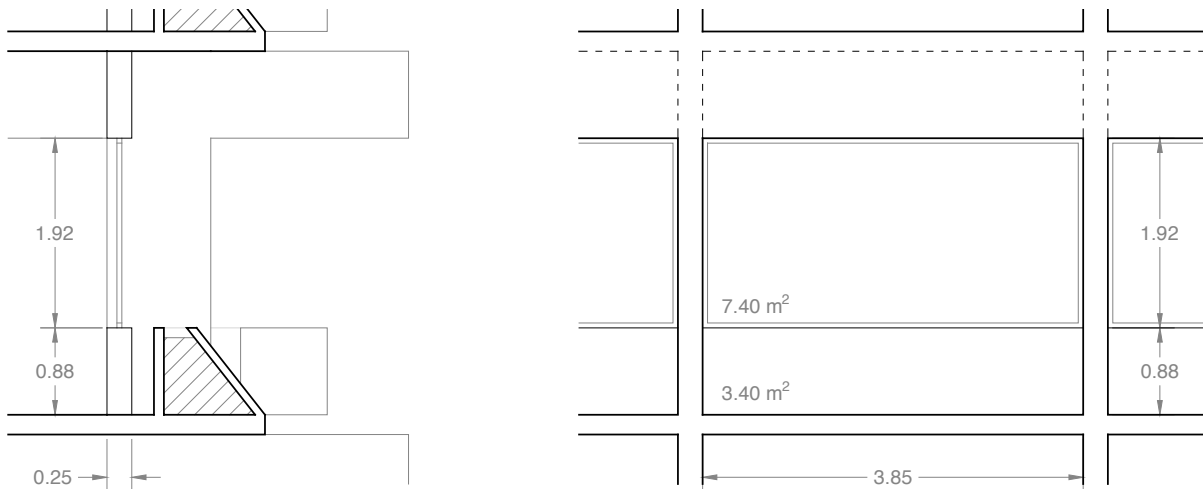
Sección y alzado de la fachada tipo de las plantas 1 y 2. Cotas en metros. [Dibujos del autor]
